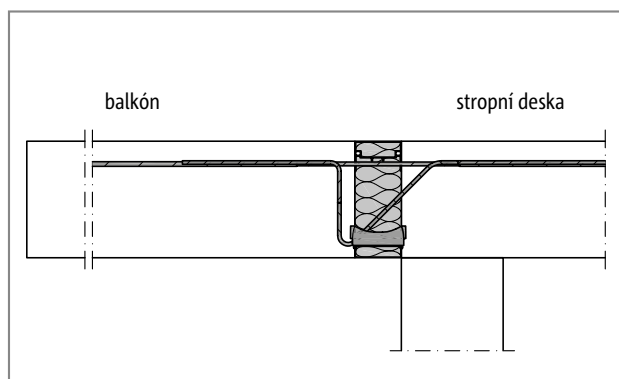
Schöck Isokorb® typ K: Uložení v nehořlavých stavebních materiálech, REI30
